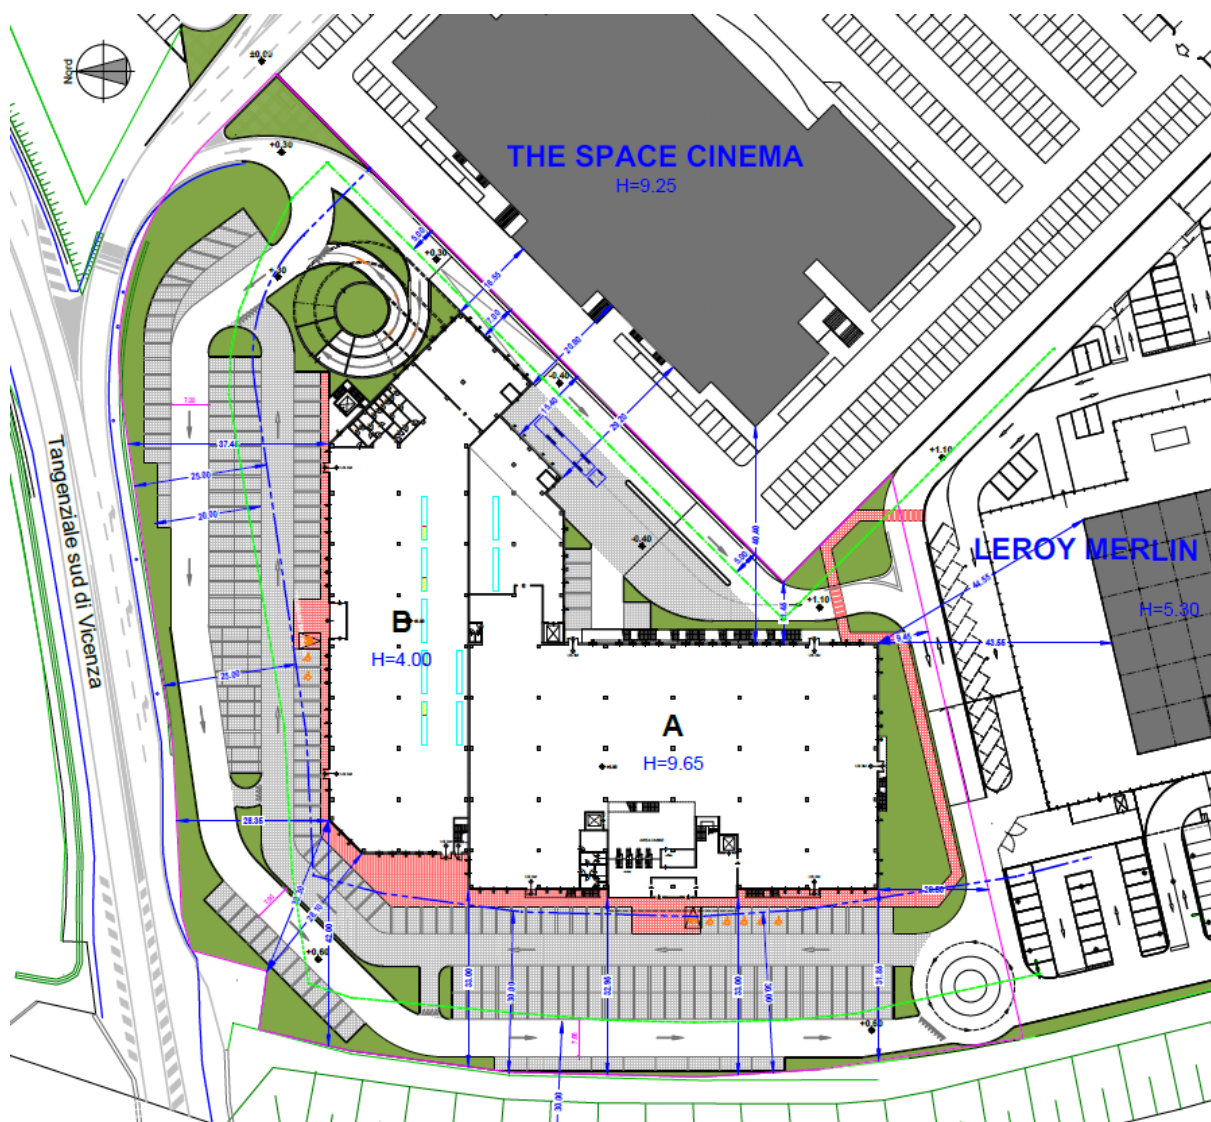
Planimetria Edificio “E” (Tavola E-01)
